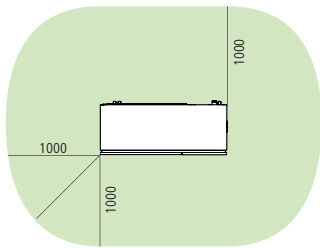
Zone de protection: installation devant un bâtiment [mm]
